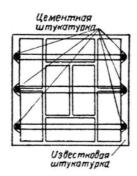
Наружное вертикальное армирование кирпичной кладки
